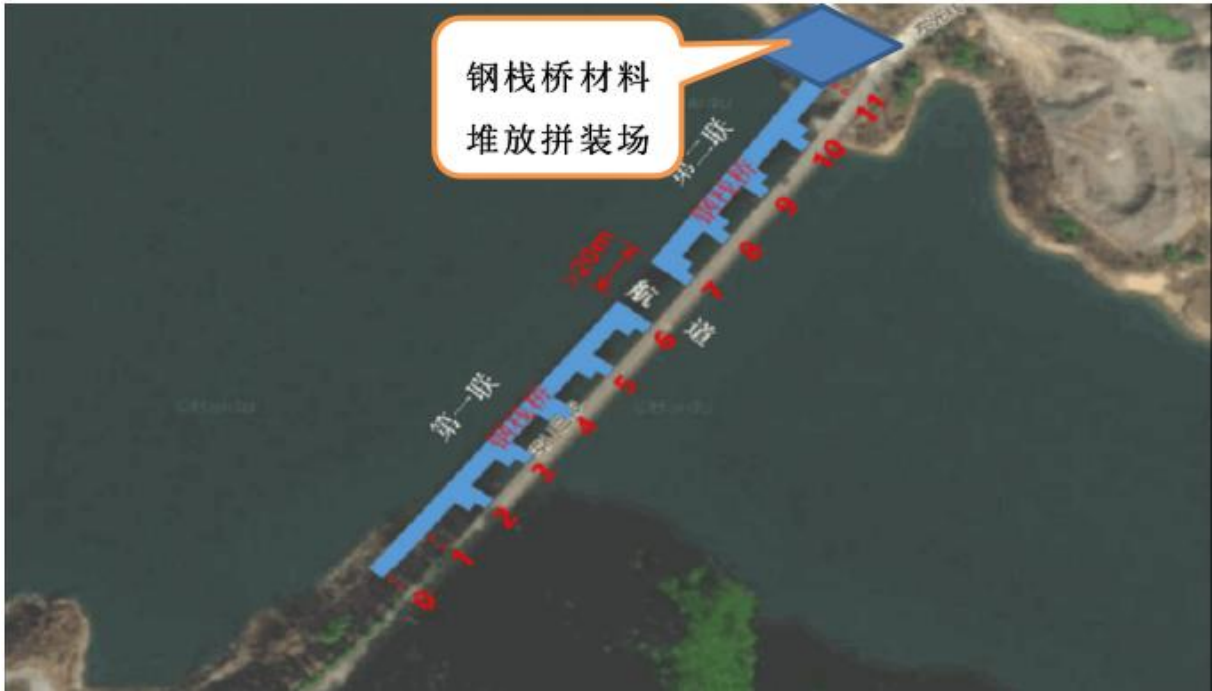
叶琪二桥施工平面布置图（含材料堆放及拼装场）
